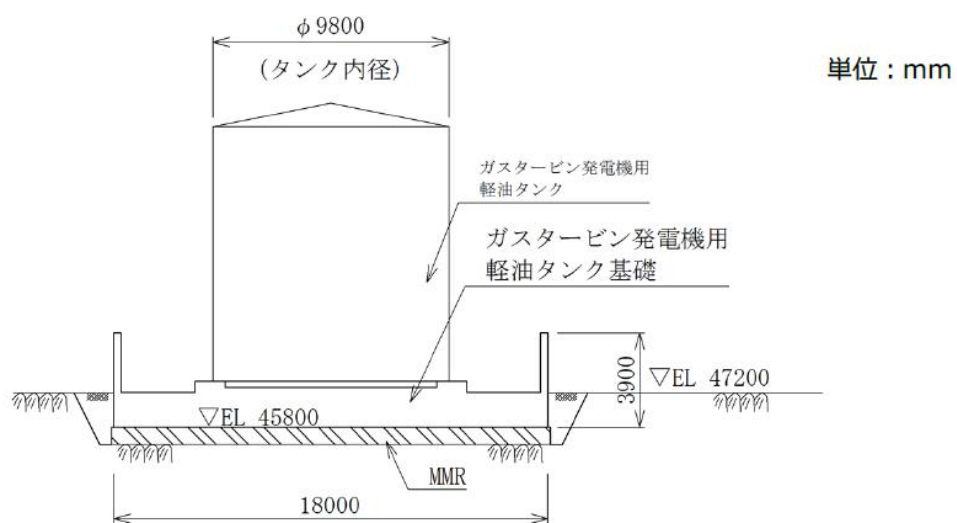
ガスタービン発電機用軽油タンク基礎 断面図 (B-B断面)
